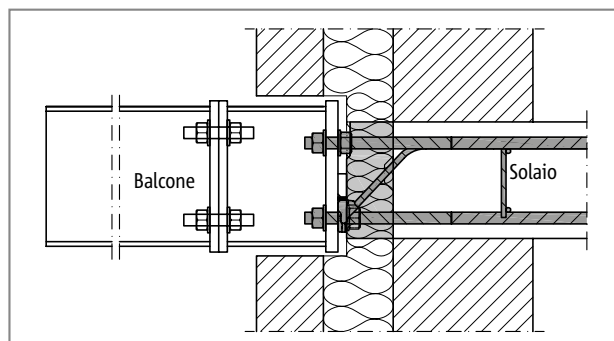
Schöck Isokorb® T tipo SKP: materiale isolante nell'interposto isolamento; con l'elemento di collegamento in opera tra Isokorb® e balcone si garantisce alla costruzione maggiore flessibilità
